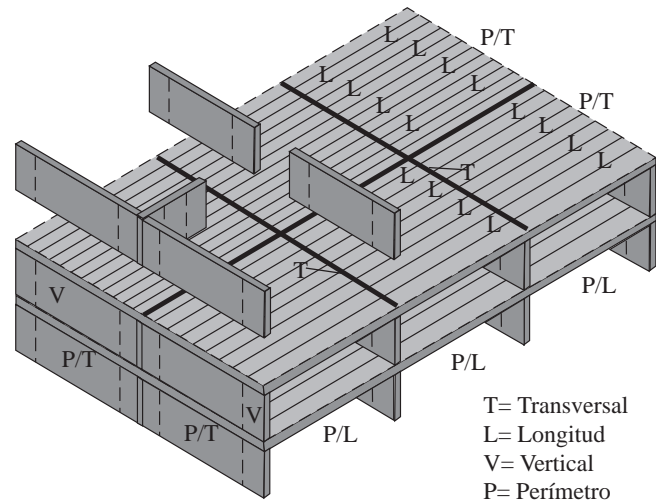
Disposición típica de amarras de tracción en estructuras de grandes paneles.
